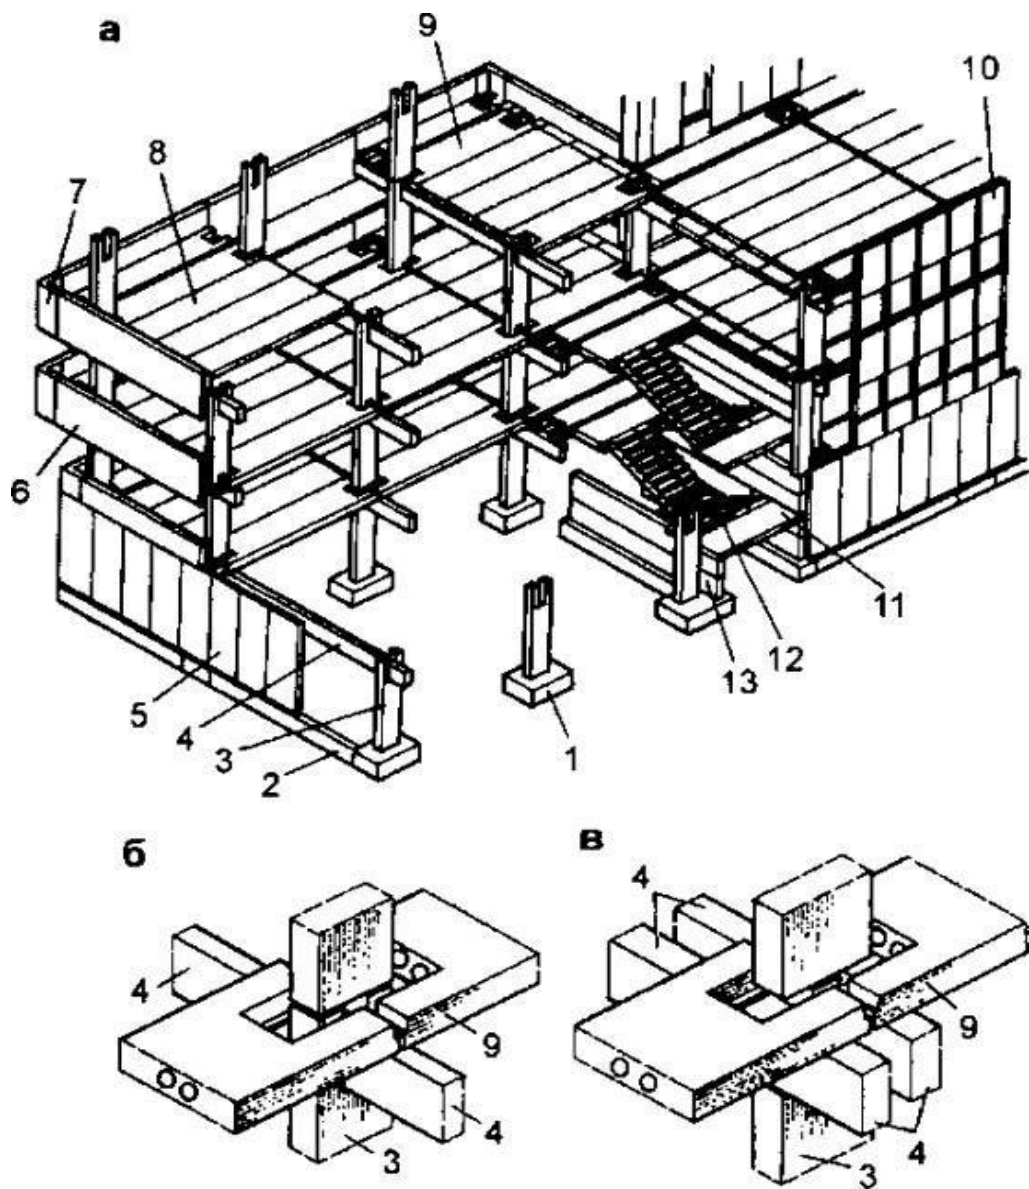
Каркасна будівля системи: а – основні елементи будівлі; б – одноригельне рішення вузла каркаса; в - дворигельний; 1 – фундамент склянкового типу під колону; 2 – стрічковий монолітний фундамент під стіну підвалу; 3 – колона; 4 – ригель; 5 – панель стіни підвалу; 6 – рядова горизонтальна панель зовнішньої стіни; 7 – кутовий елемент стіни; 8 – рядова плита перекриття; 9 - плита-розпірка; 10 – панель стіни вертикальної розрізки; 11 - сходовий майданчик; 12 - сходовий марі); 13 - панель стіни сходової клітки
